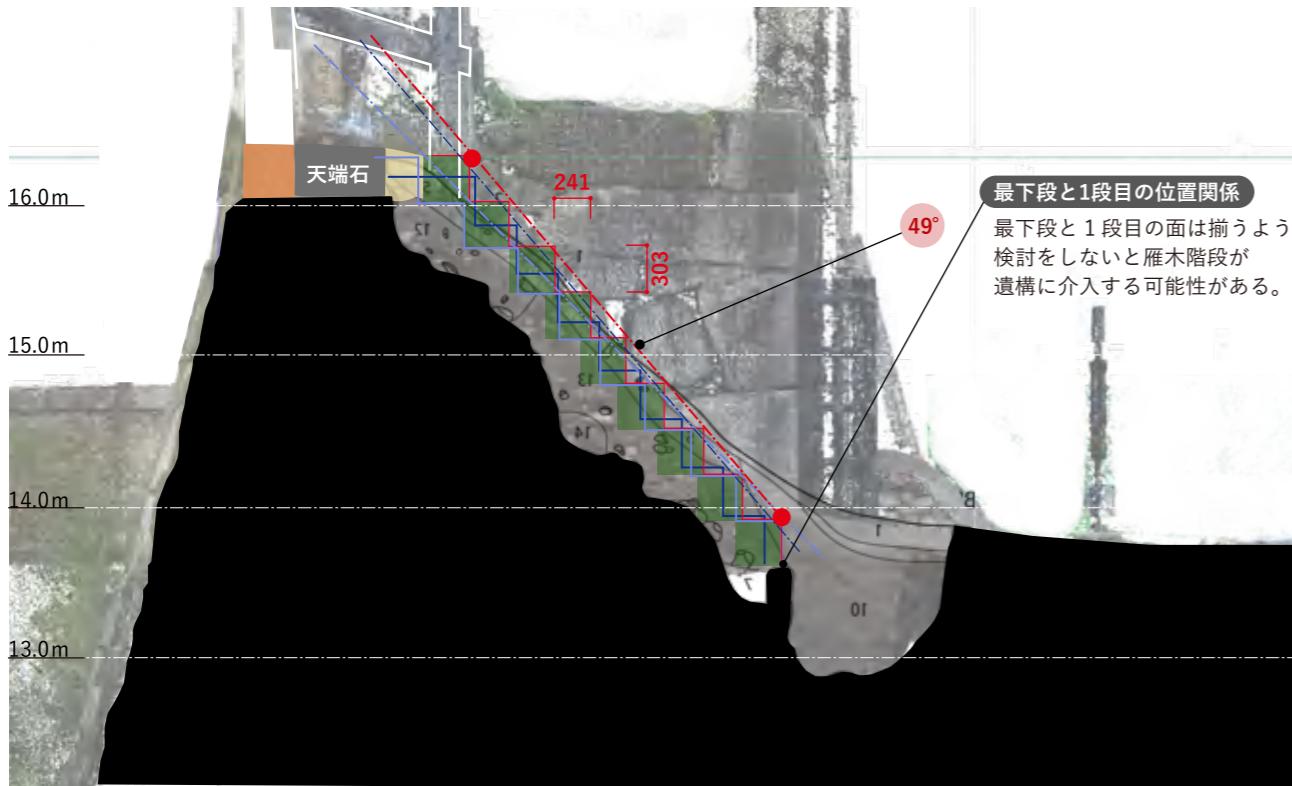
断面 B 断面図 + 陰影立面図 (見通し)
